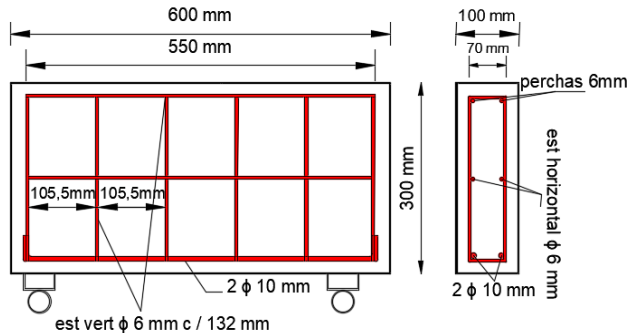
Geometría y detalle de armado de especímenes con armadura de corte reglamentaria según norma CIRSOC 201-05 (9)
